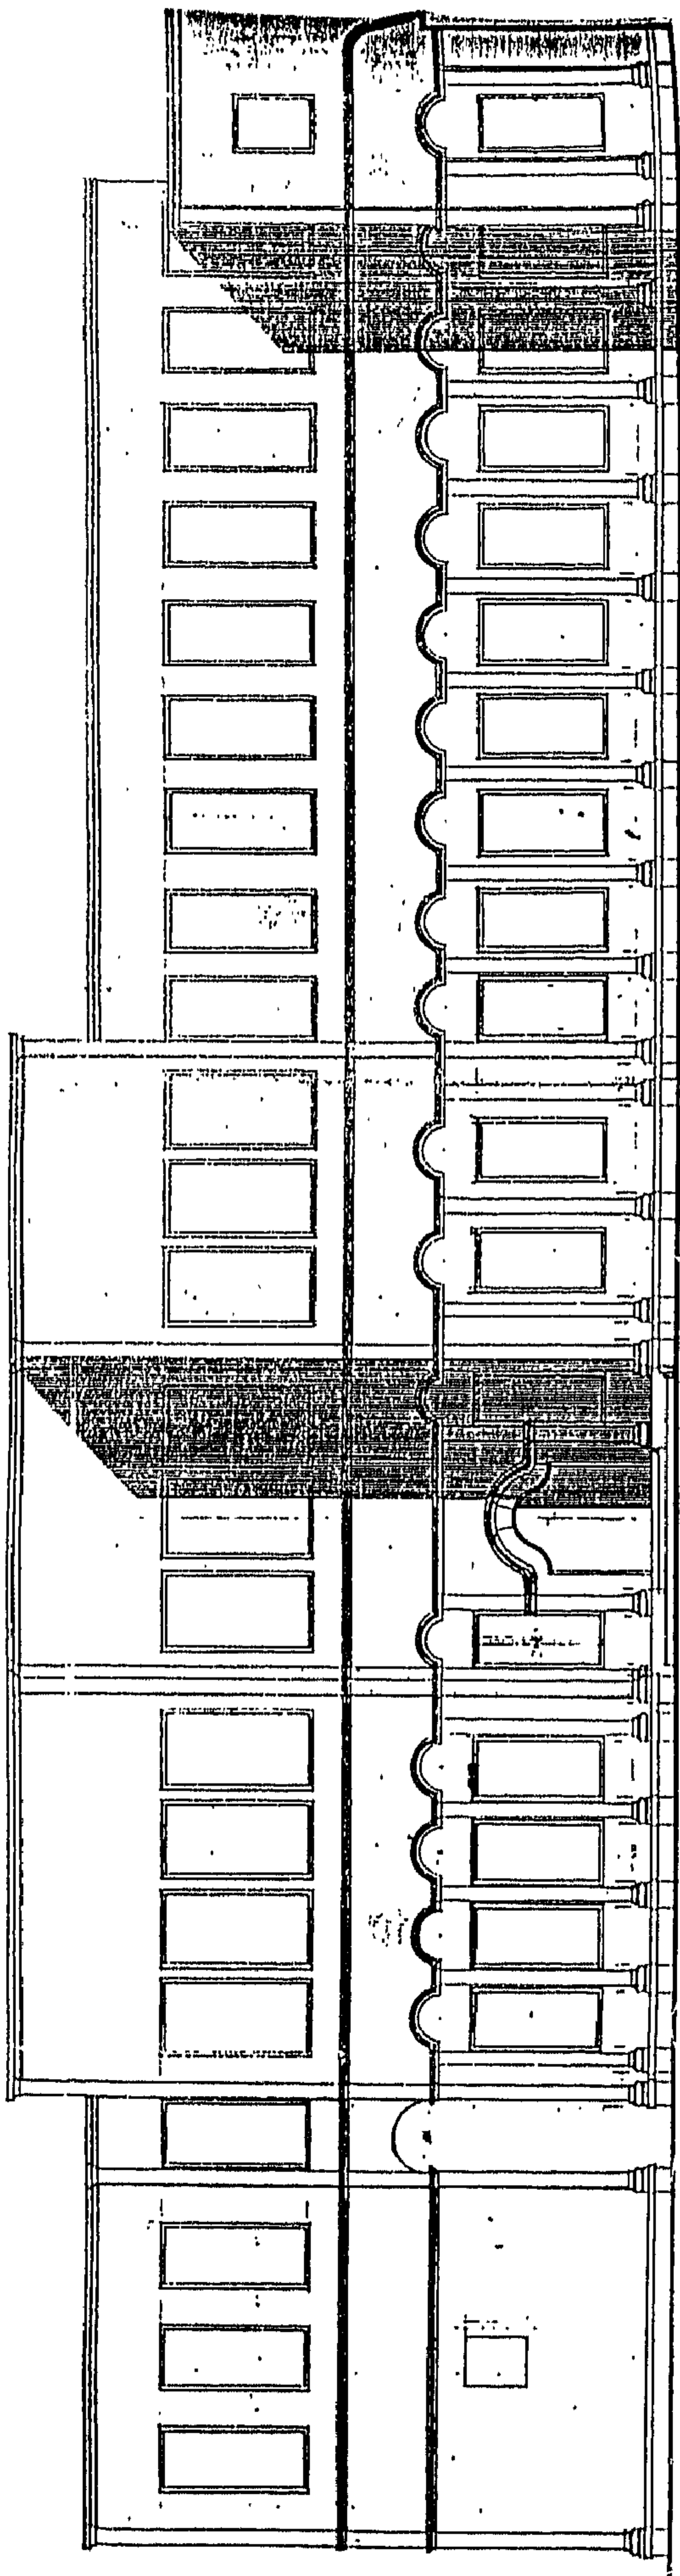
مسقط أفقي تخيلى لما كان عليه الدور الاول من مدرسة القلعة.
